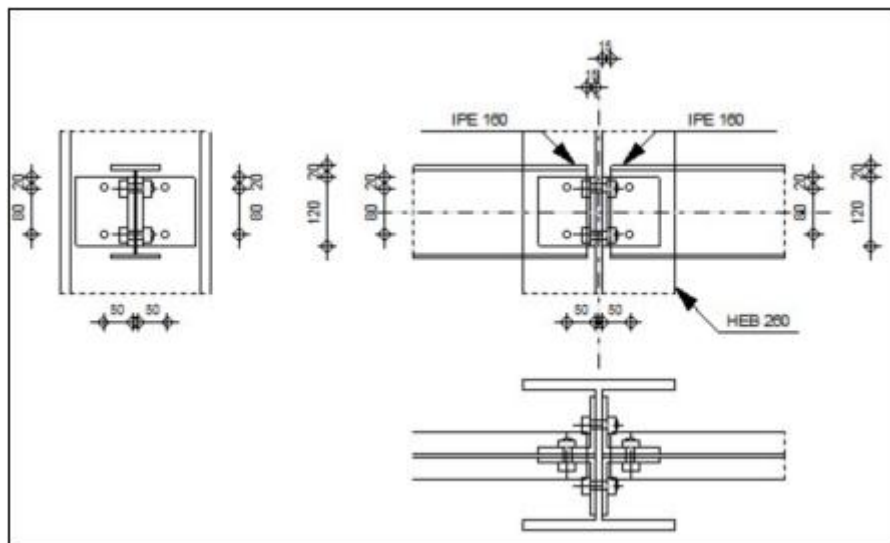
Représentation de l'assemblage poteau – poutre sablière.
